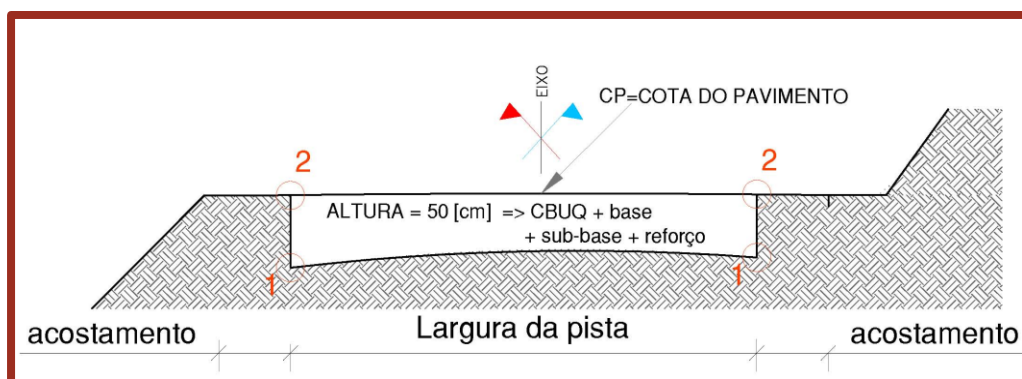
Demonstração do cálculo volumes da Caixa de pavimento
